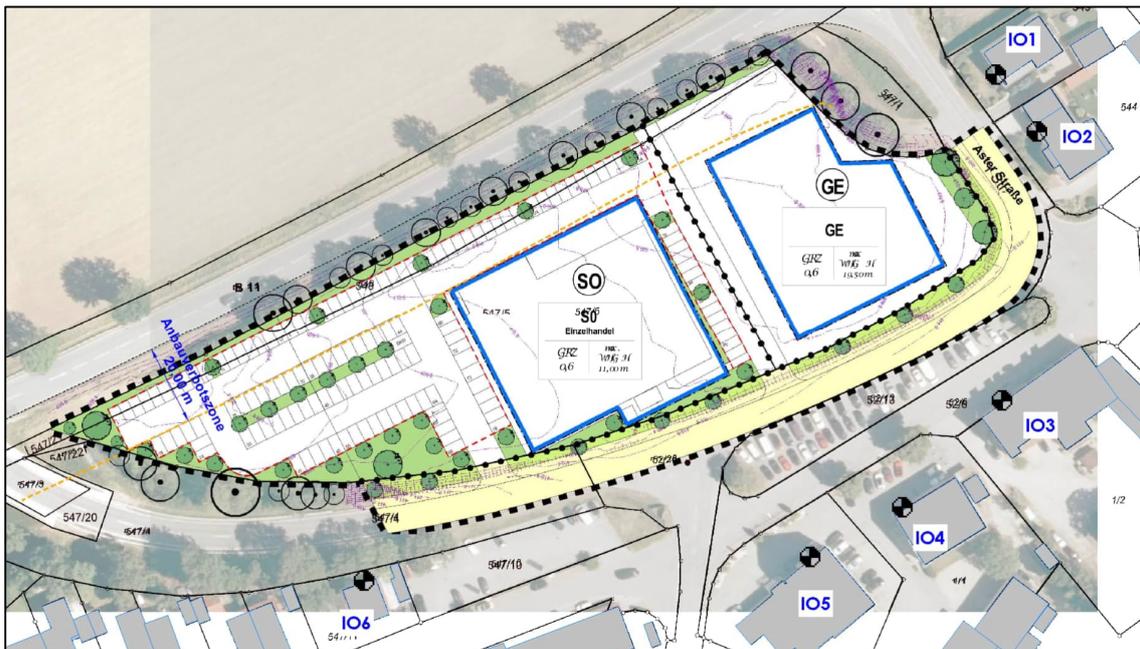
Lageplan mit Darstellung der maßgeblichen Immissionsorte (IO)
